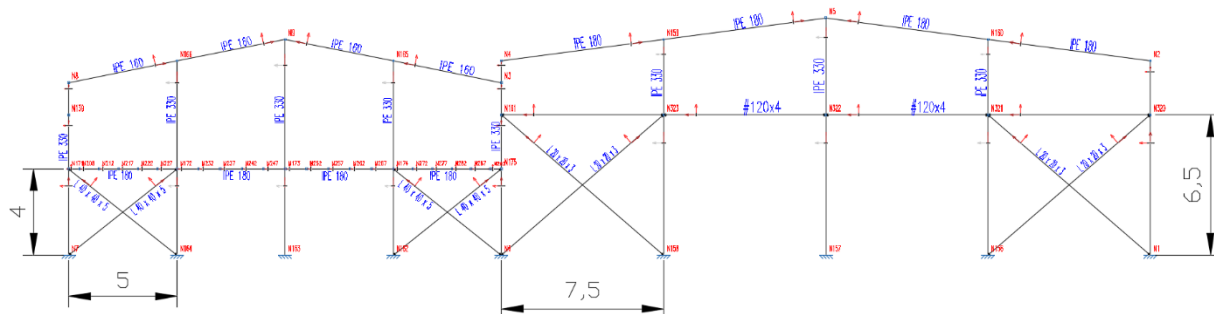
Pórtico de fachada de la nave principal y trasero de la secundaria don detalle de perfiles y nudos
